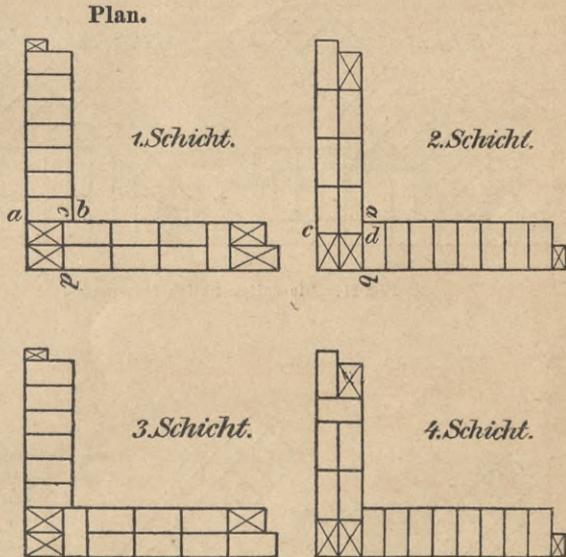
Rechtwinklige Mauerecke und Mauerecke mit Anschlag, 1 Stein stark.
